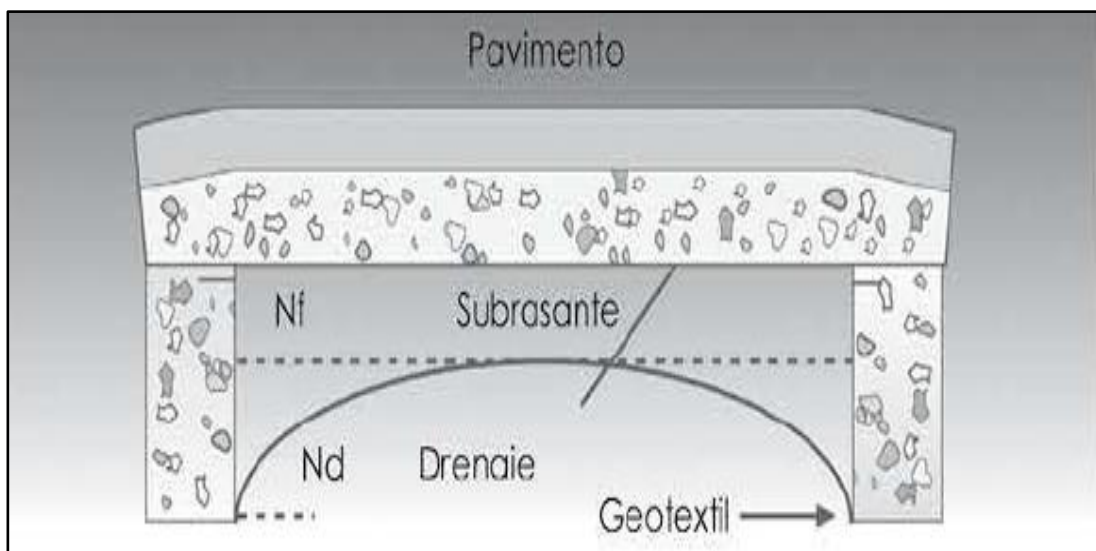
Sección transversal de un sistema de subdrenaje lateral en vías.
